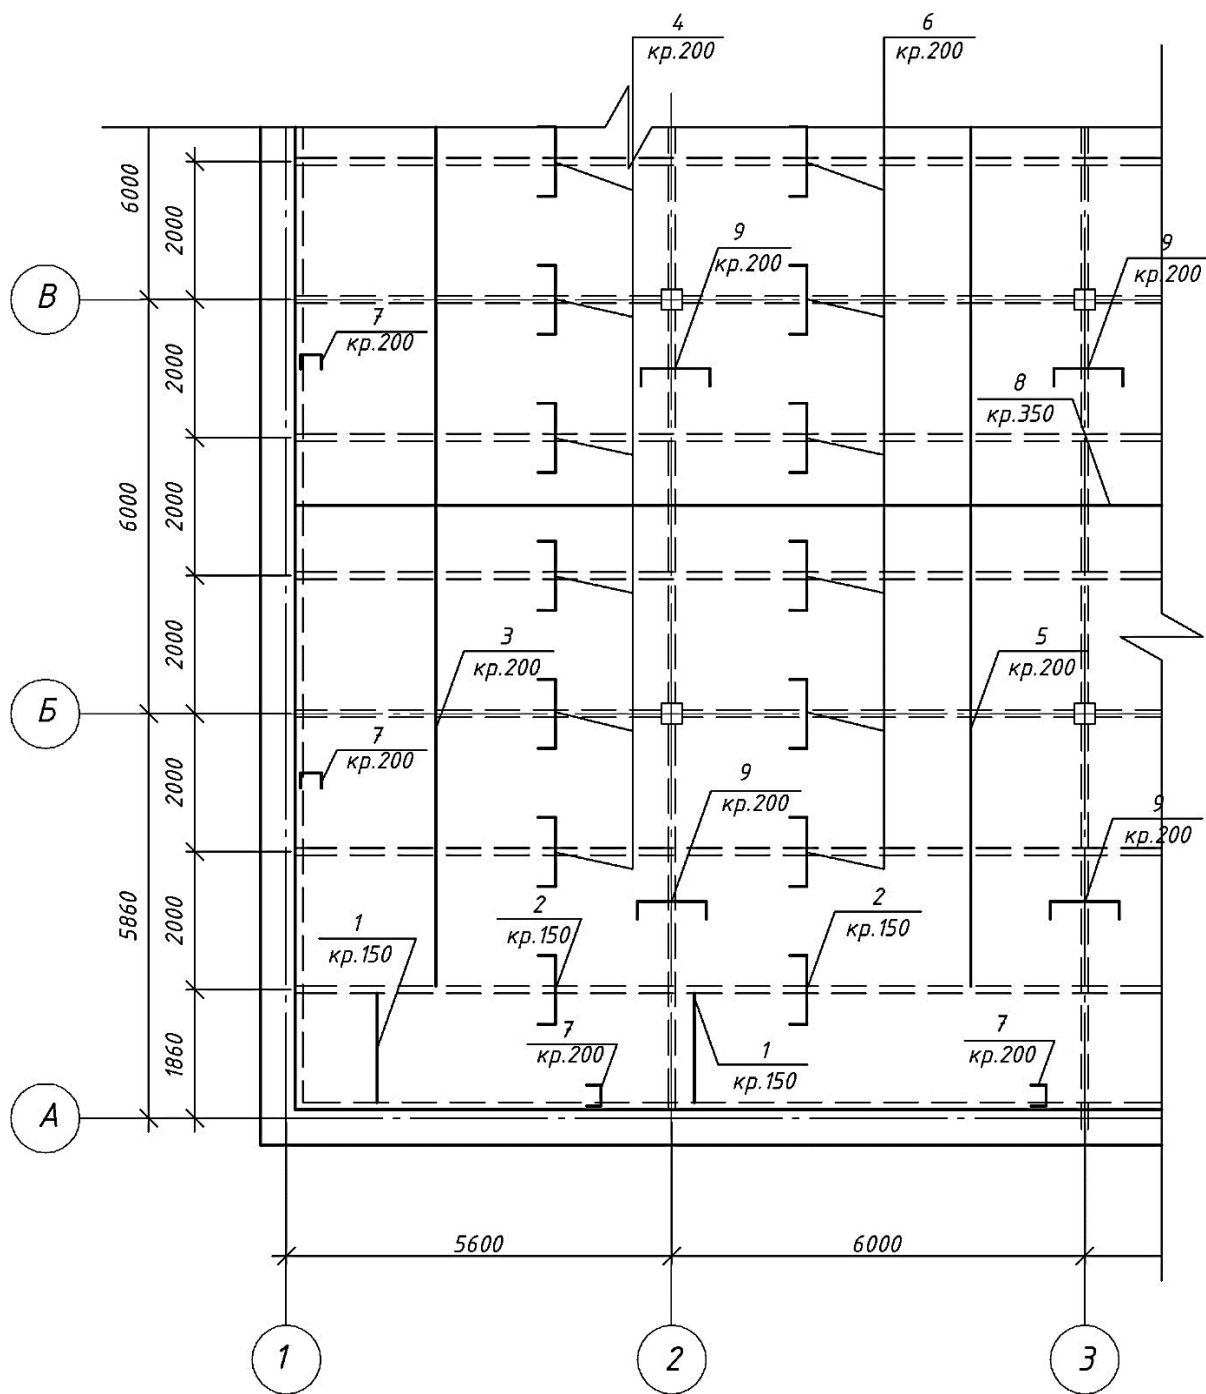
Схема армування плити в'язаними сітками без відгинів
